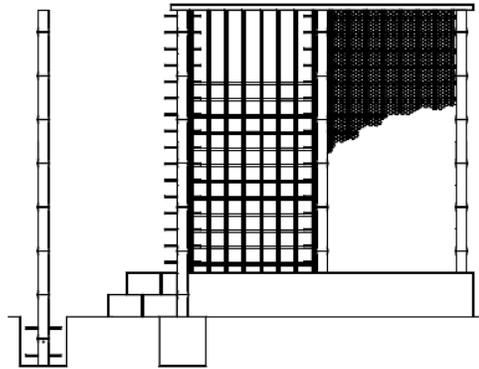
Denah, bambu untuk lantai (Purwito, 1995).
